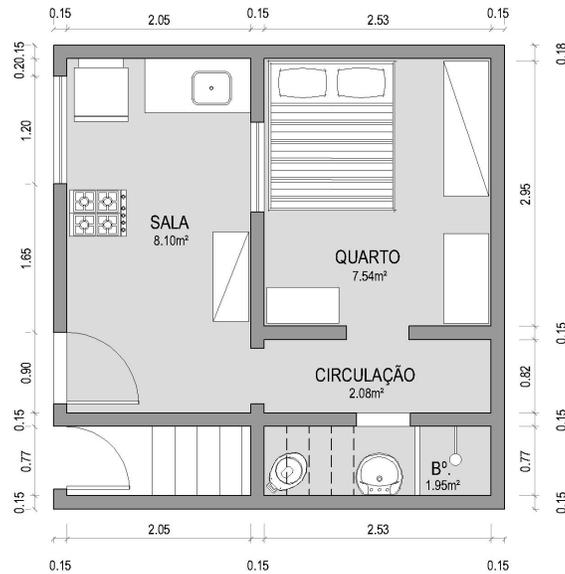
Planta baixa da casa do Sr. Josimar. Área: 19,67 m².
